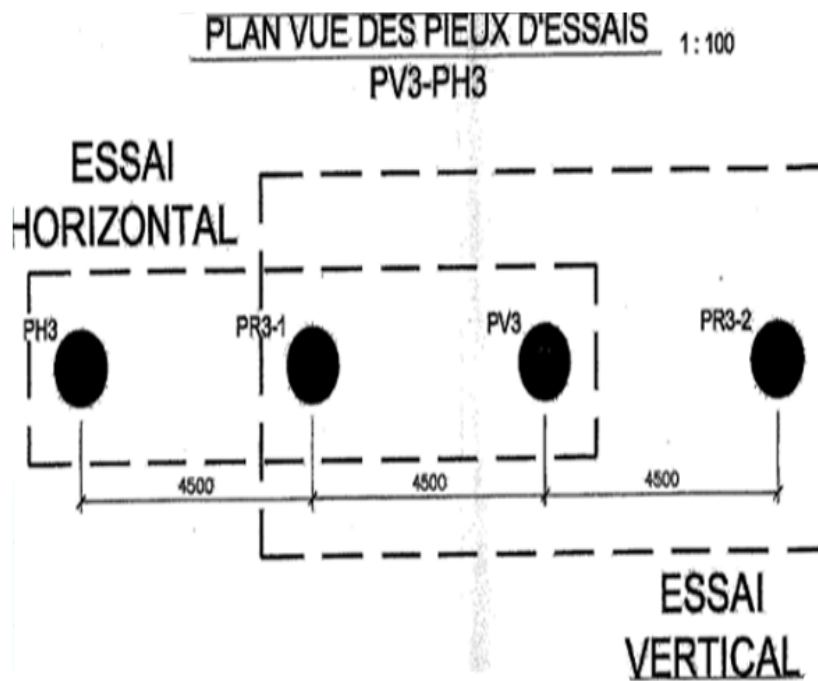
vue en plan de pieu d'essai PV3-PH3.
